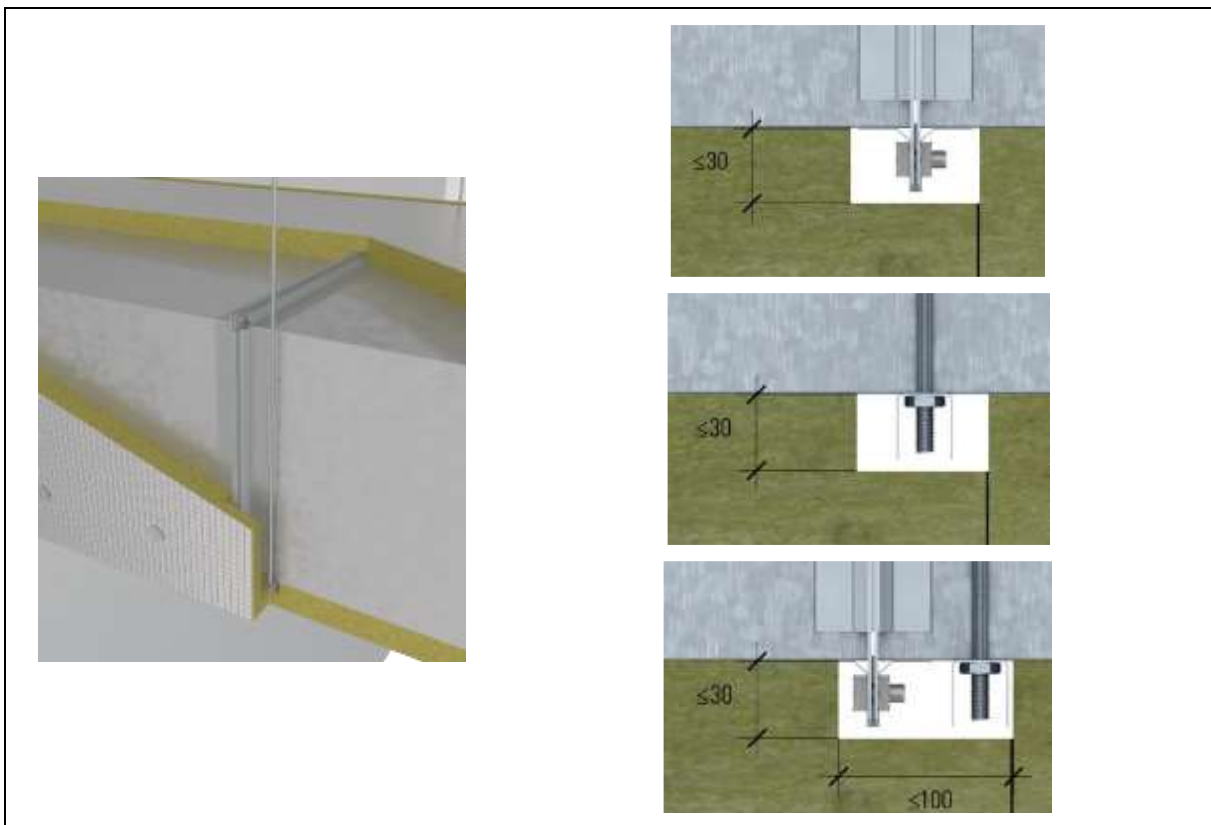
Aislamiento de protección contra el fuego cubriendo elementos de suspensión y juntas de conducto.
